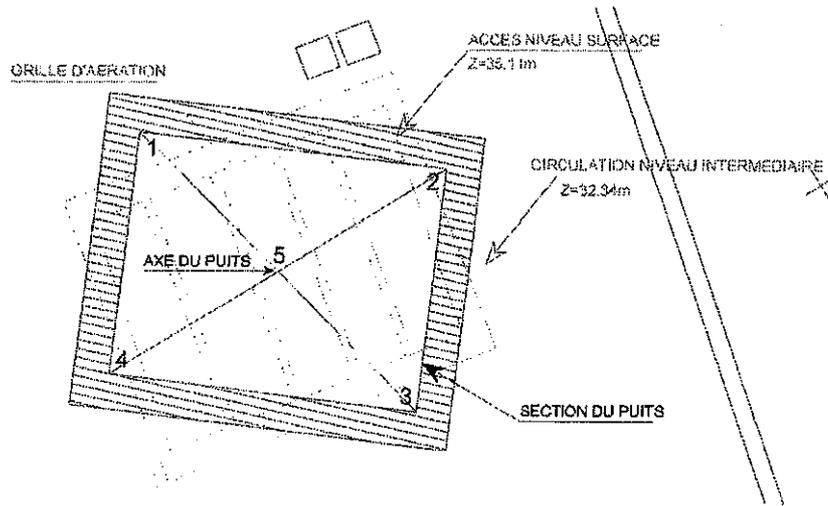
Vue en plan des ouvrages (situation de l'existant)
